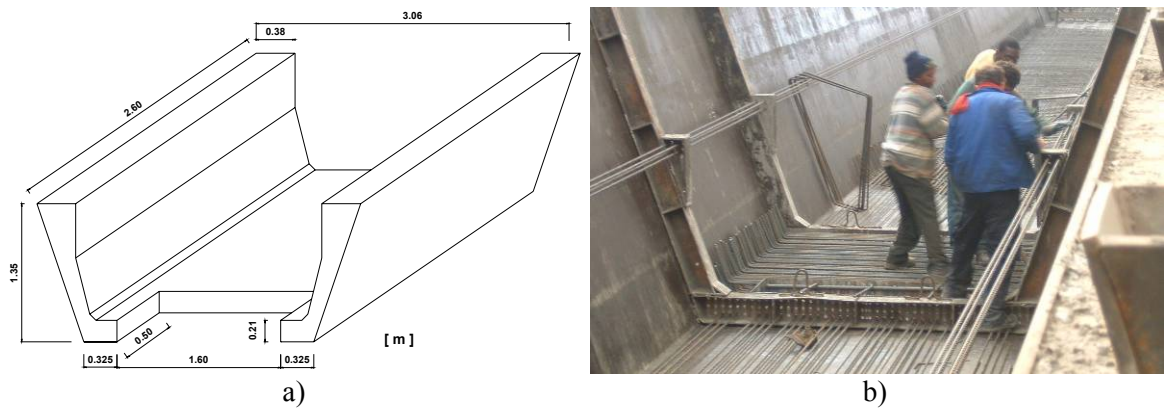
a) Dimensões da viga-caixão betonada no ensaio à escala real; b) Preparação das armaduras no troço de elemento a betonar
